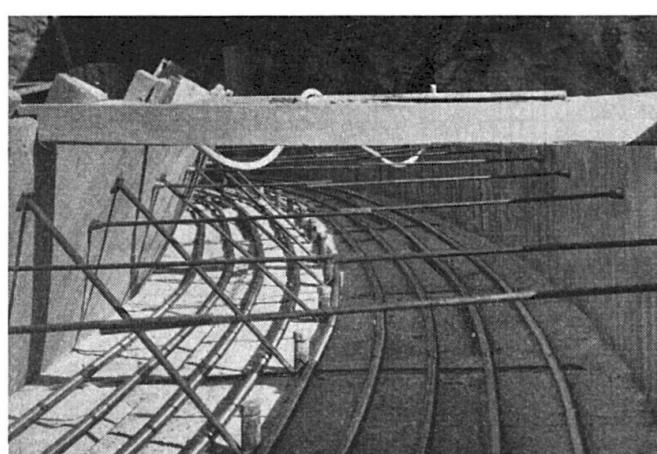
Câbles horizontaux avant le bétonnage, dans la zone du pied du barrage.
